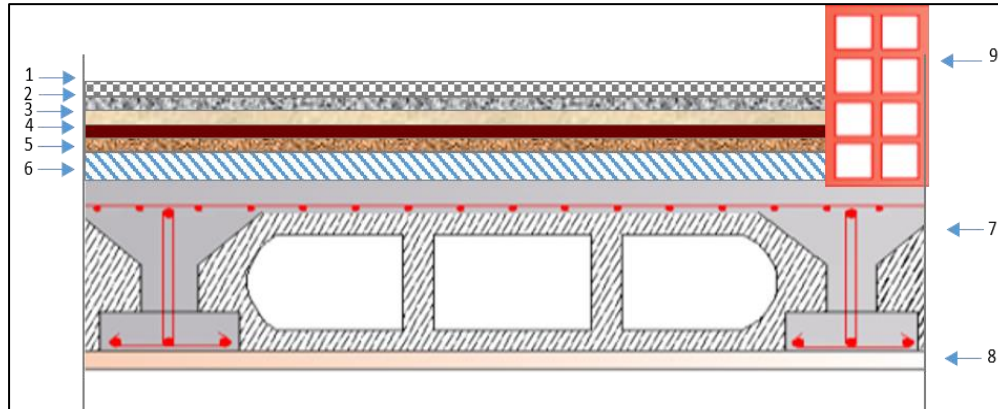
Coupe verticale du plancher terrasse accessible
